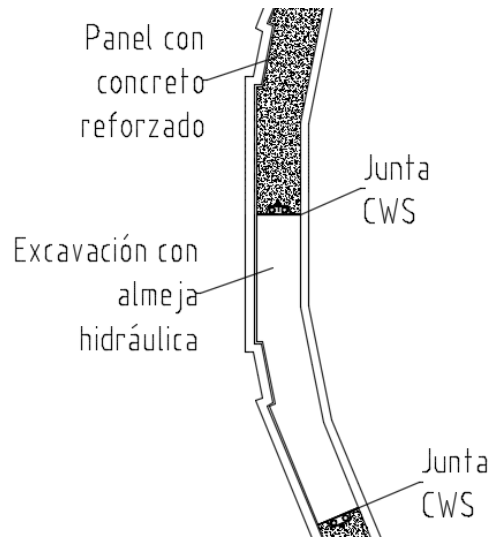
Secundario: Excavación de la zanja. Paneles adyacentes ya fueron colados.⁴⁷
